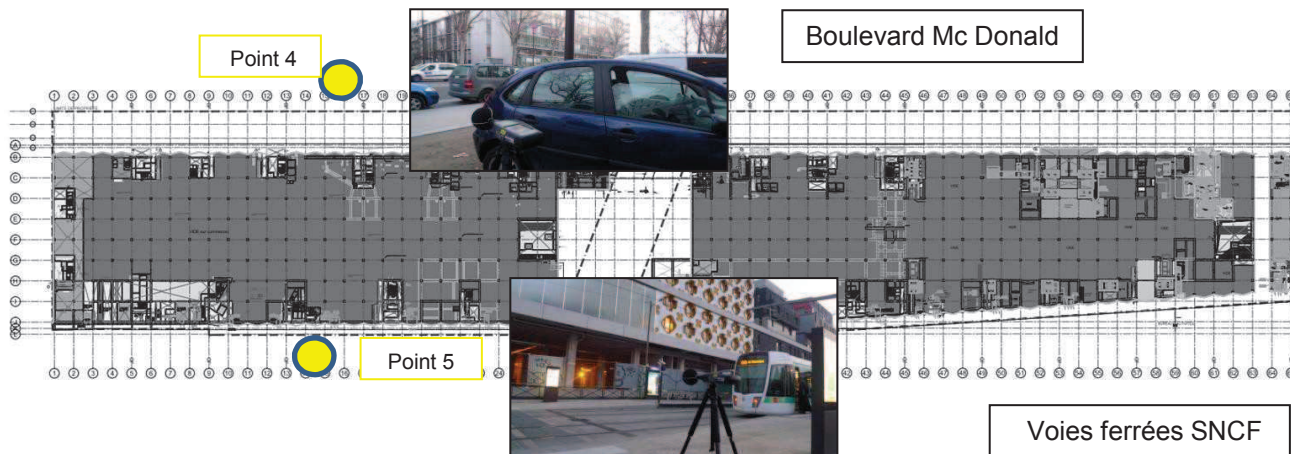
Localisation des points 4 & 5 situé en bordure du projet au niveau du RDC
